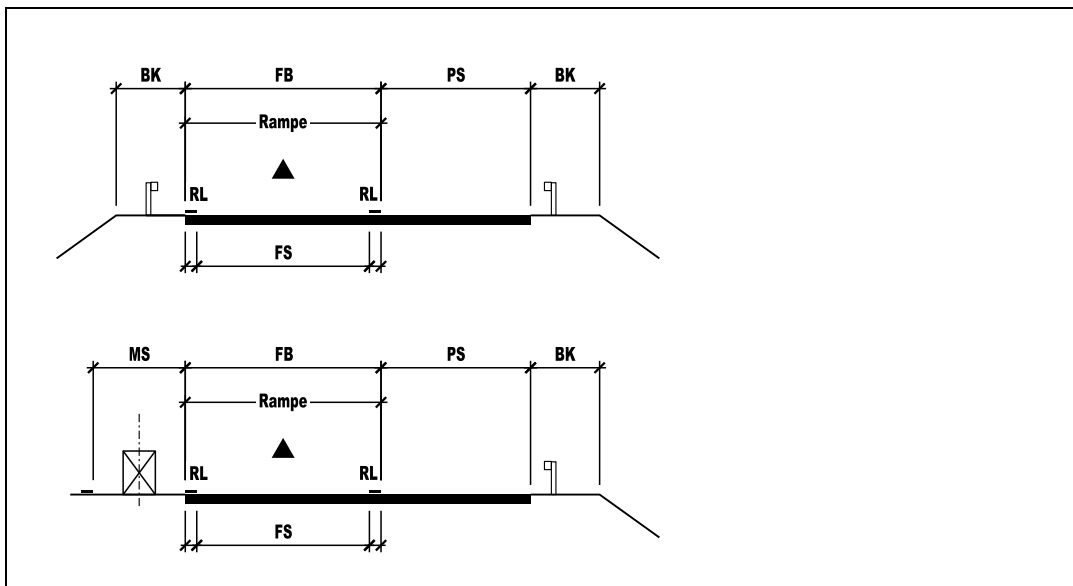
Elemente des Normalprofils einer Rampe mit Bankett oder Richtungstrennung
